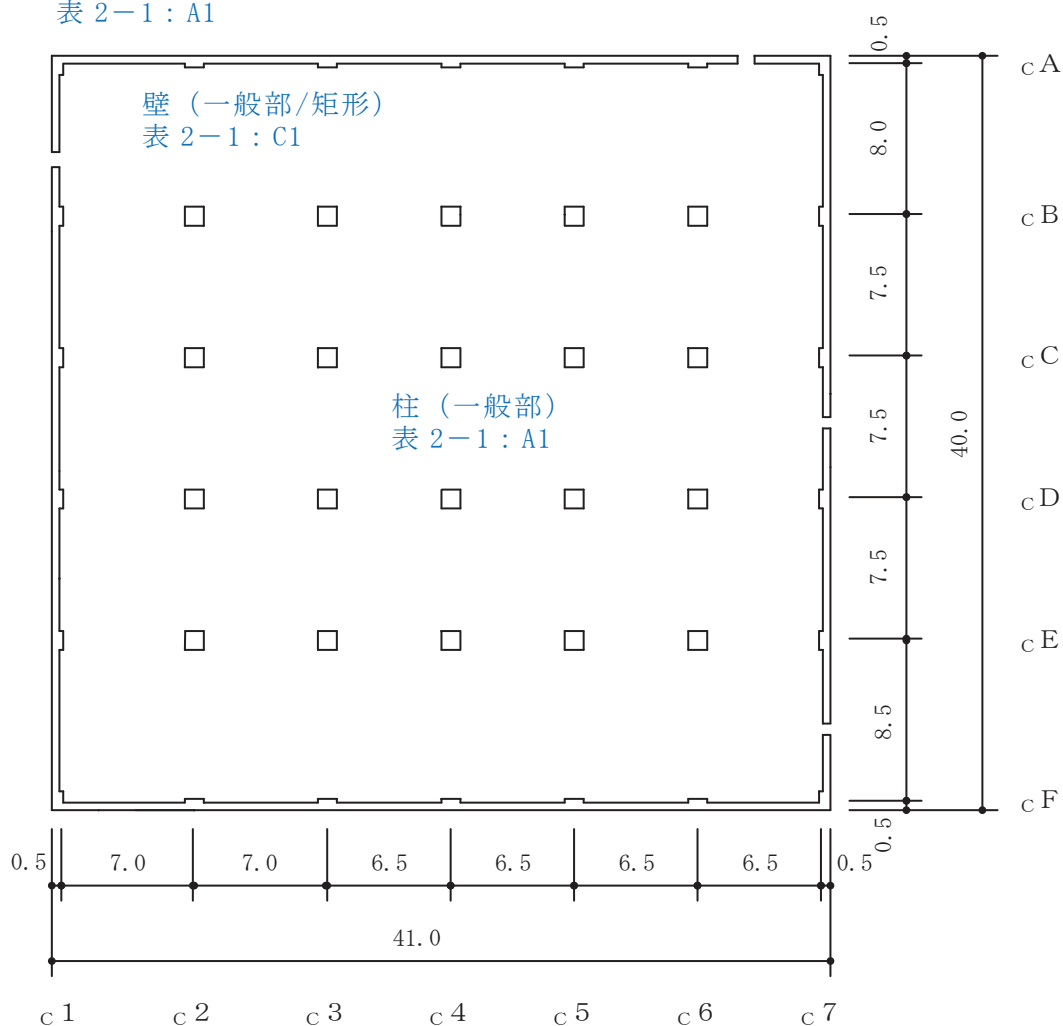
(3) 制御建屋の概略平面図 (O.P. 15.0m)
